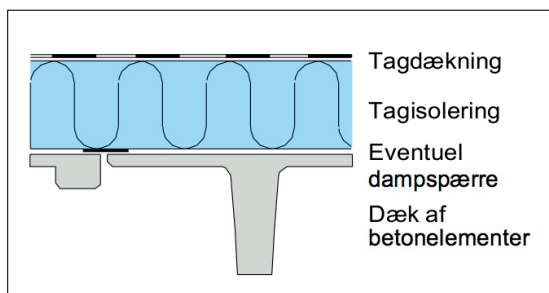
Varmt tag udført på underlag af betonelementer.
